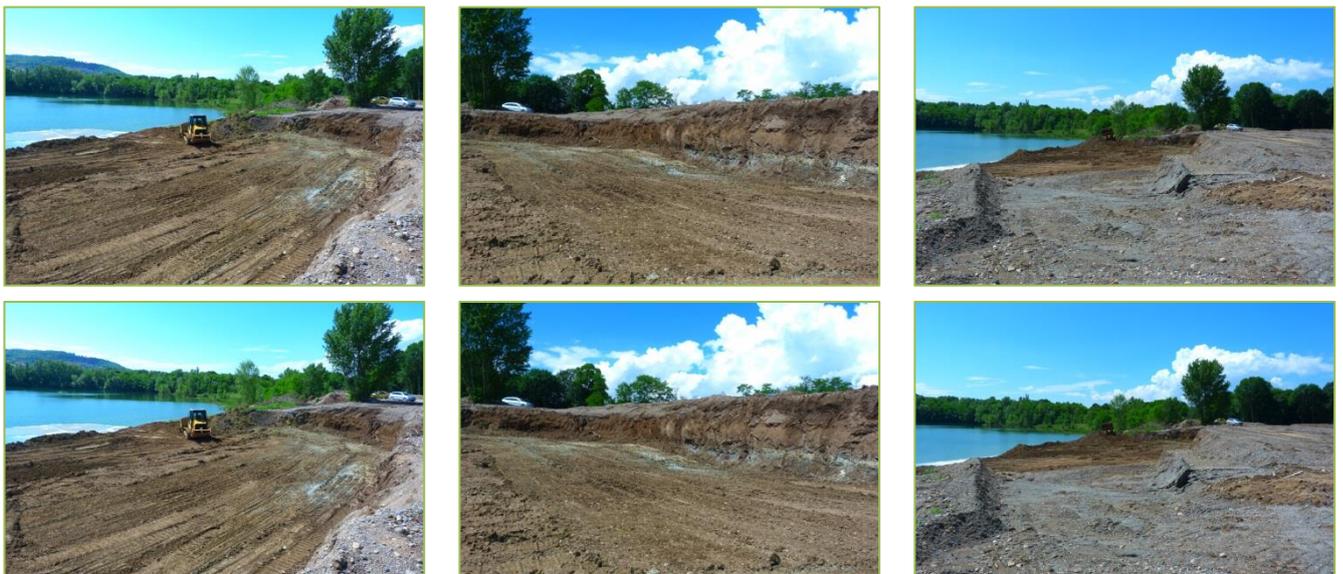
Création de la falaise et de la plage sur la berge nord-ouest de Bellerive (06/2017)
